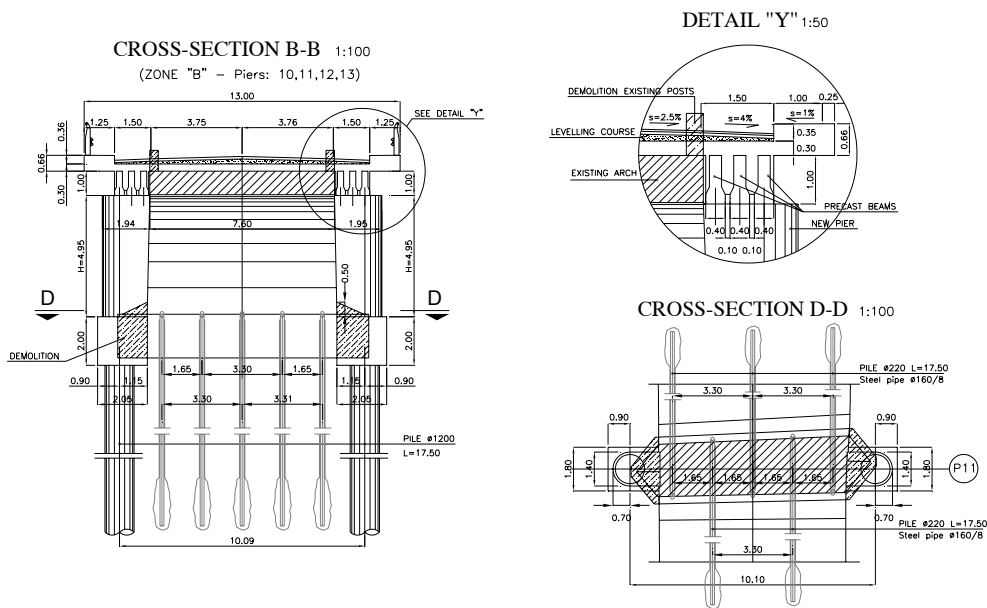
Progetto di adeguamento statico del Belices Bridge: sezione trasversale del ponte.
